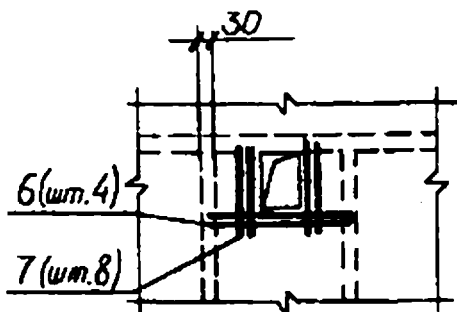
Пример изображения и обозначения на схеме армирования отдельных арматурных стержней, если их шаг не нормируется
